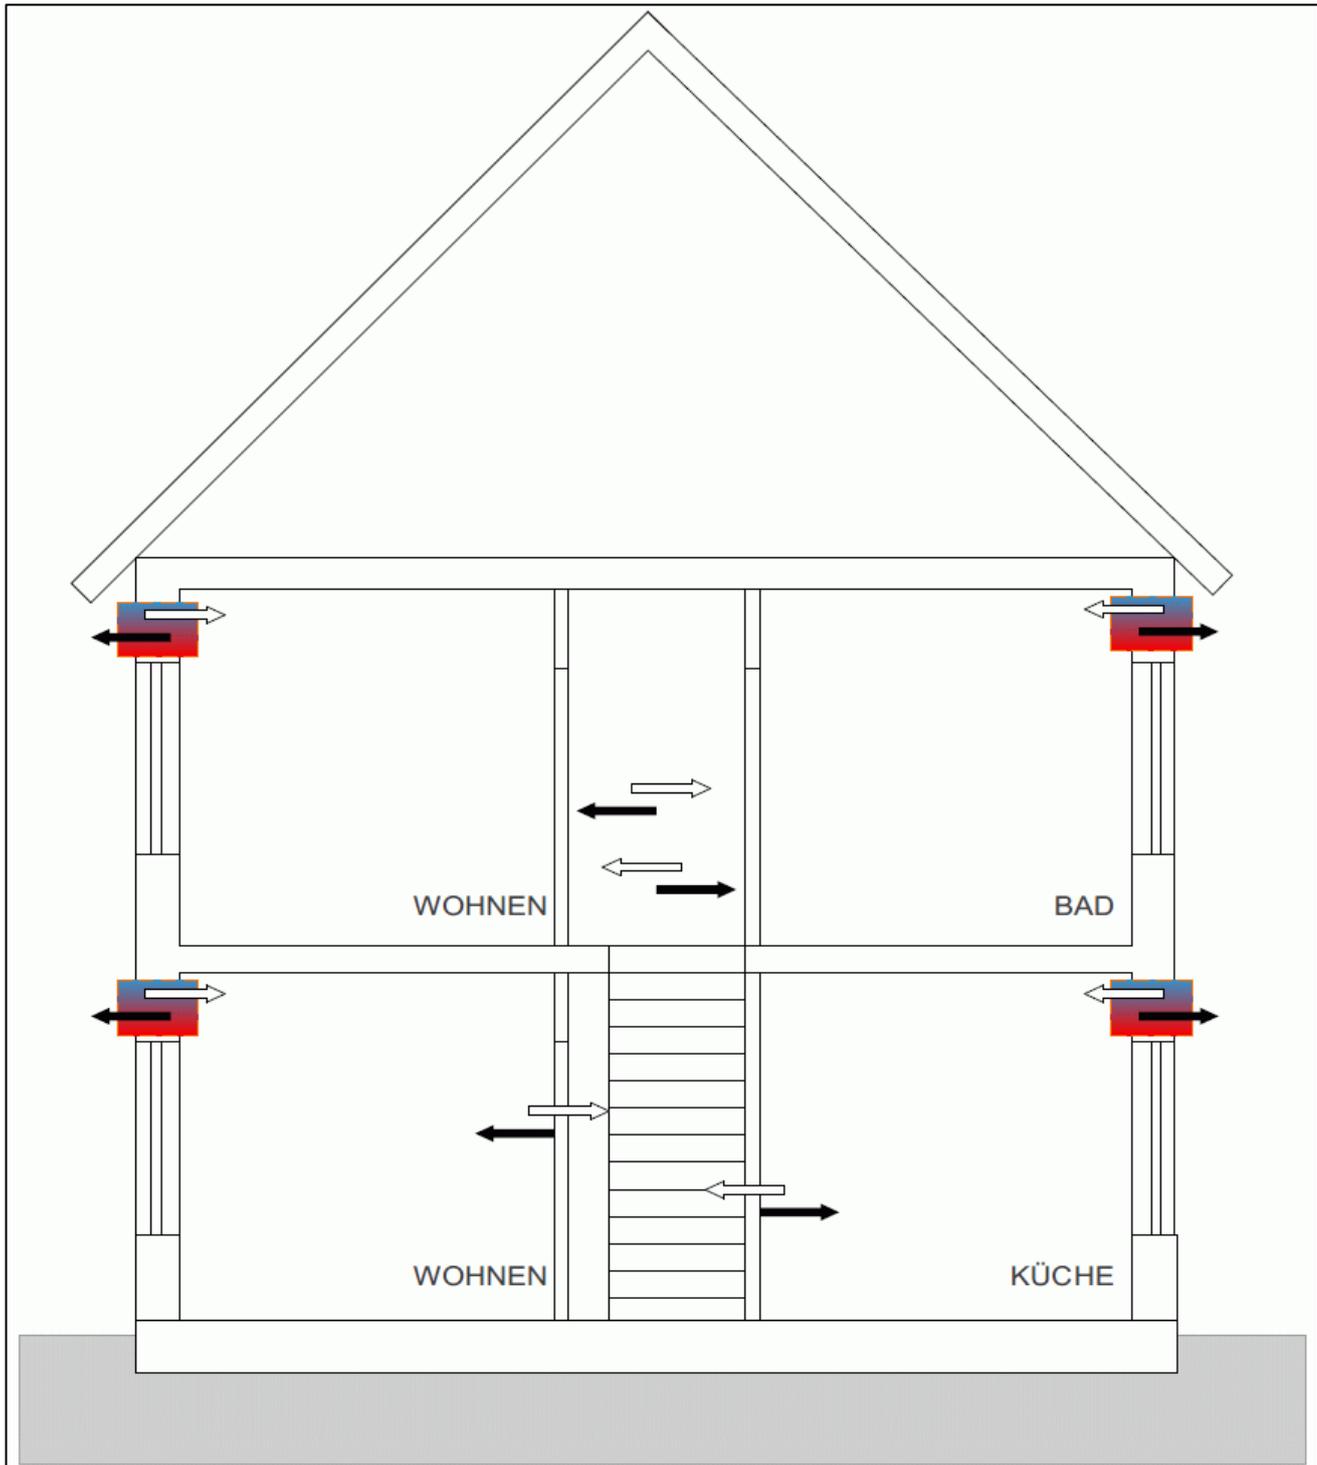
Anordnung dezentrale Lüftungsanlage, Grundriss
